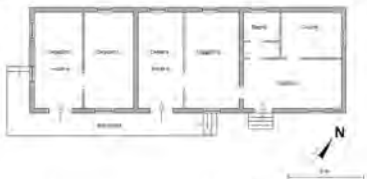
Planimetria dello stato reale rilevato del fabbricato in Comune di Potenza F.15, P.lia 332E, S.1 (1:100)
